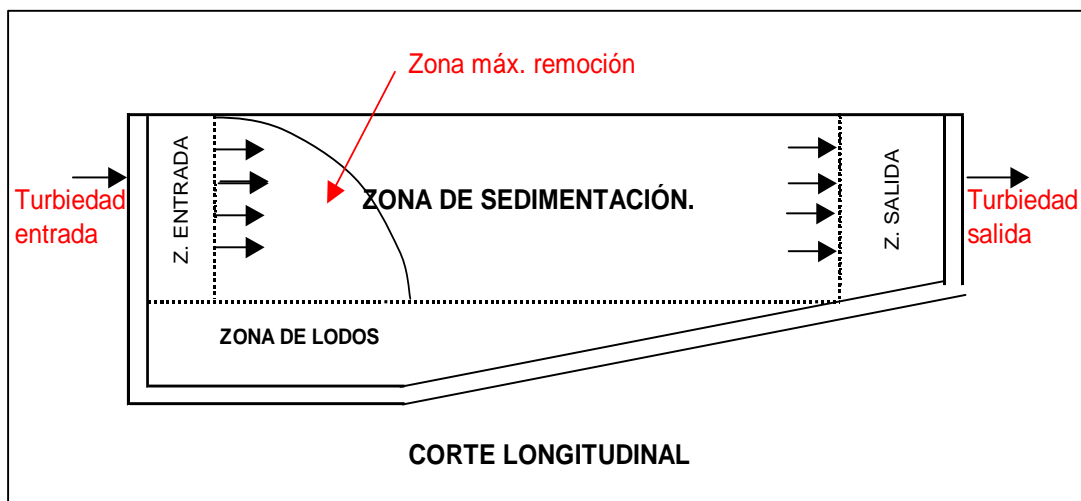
CORTE LONGITUDINAL DE LOS POZOS DESARENADORES.
